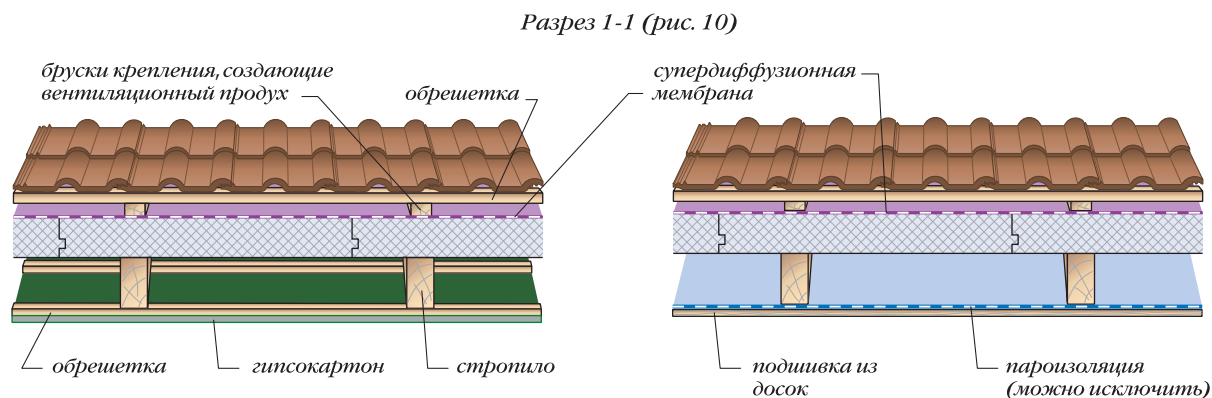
Теплоизоляция пенополистирольными плитами поверх закрытых стропил
